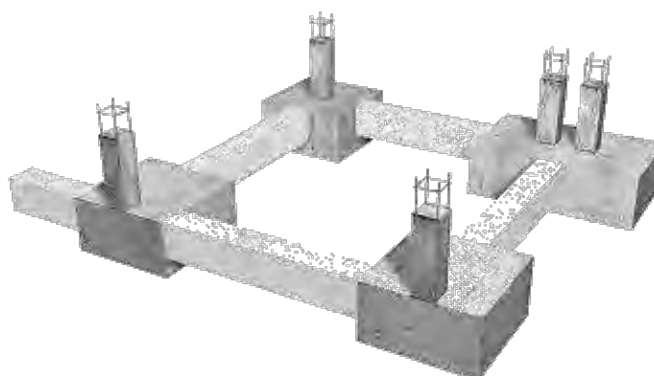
Modelo de cimentación planteado mediante zapatas
